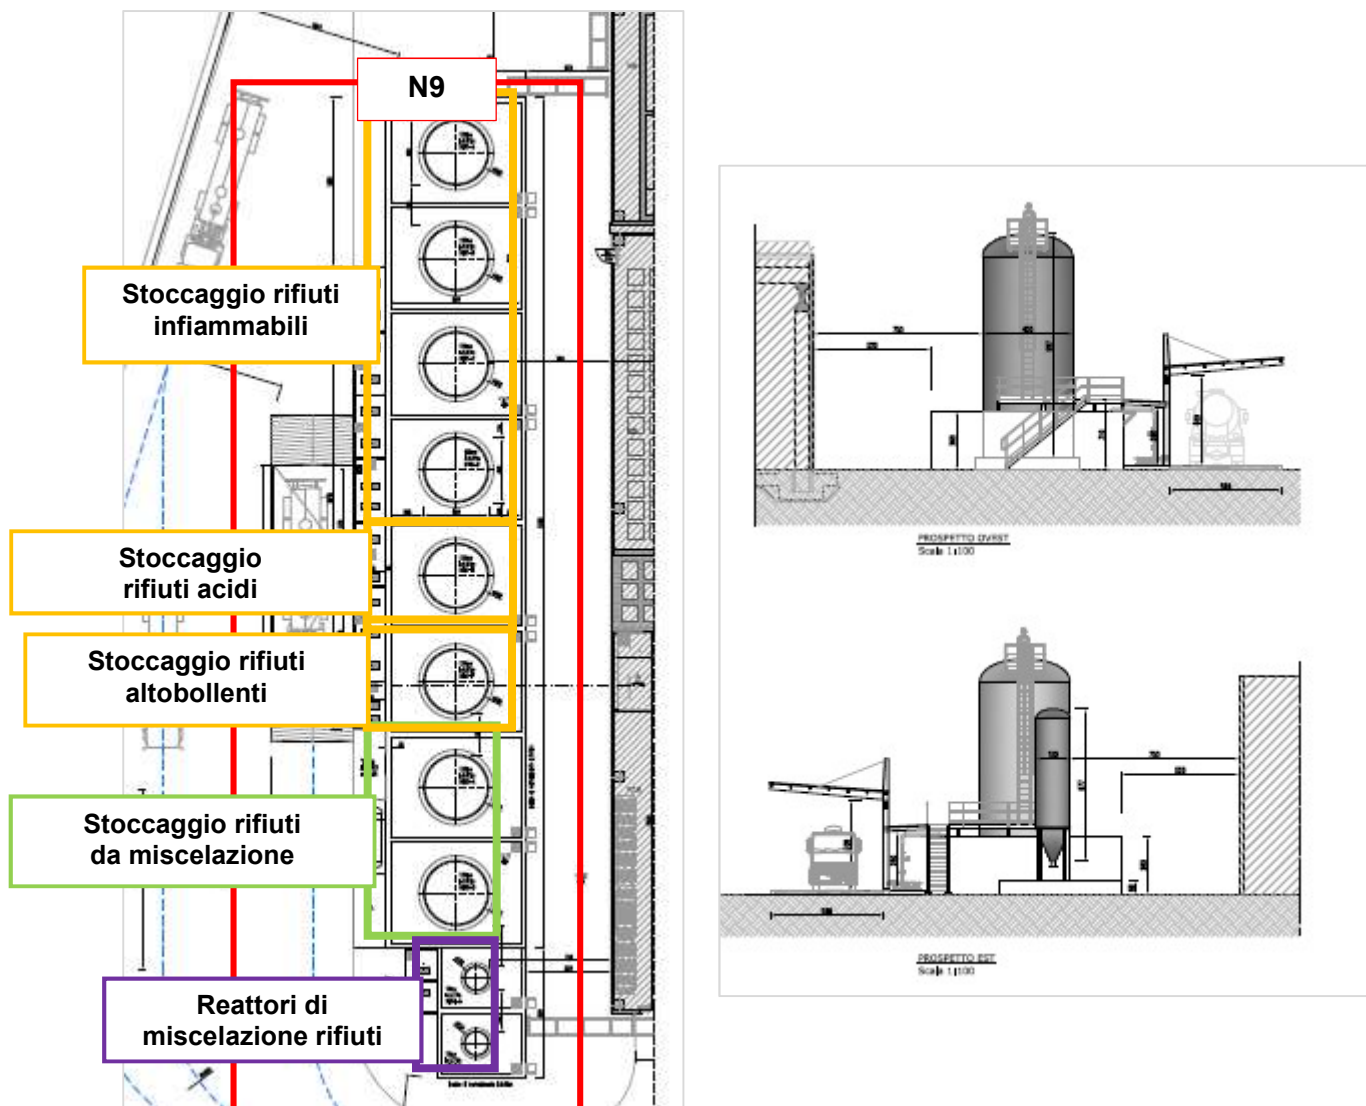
Dettaglio localizzazione Sezione N9 (sx) e prospetti EST/OVEST (dx) (Stralci elaborati CO 05 RA VA 00 D1 PL 54.00 - N9 PIANTE e CO 05 RA VA 00 D1 PL 55.00 - N9 PROSPETTI E SEZIONI)
